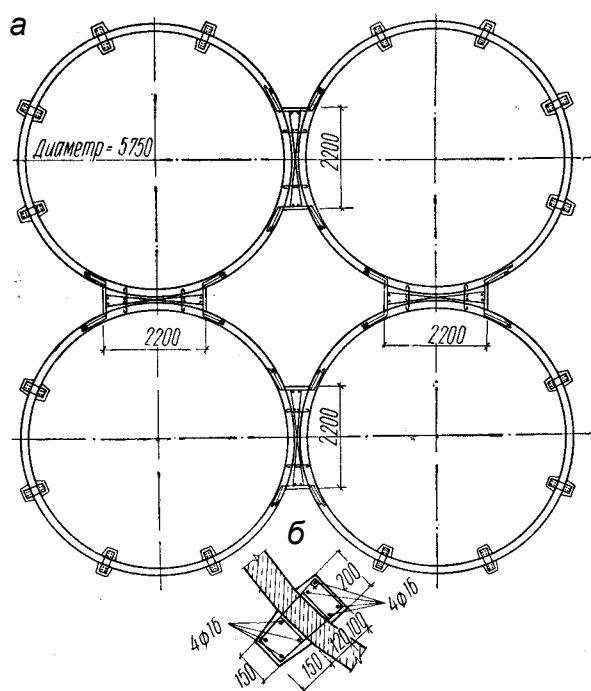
Сборные железобетонные силосы: а-план; б-деталь
